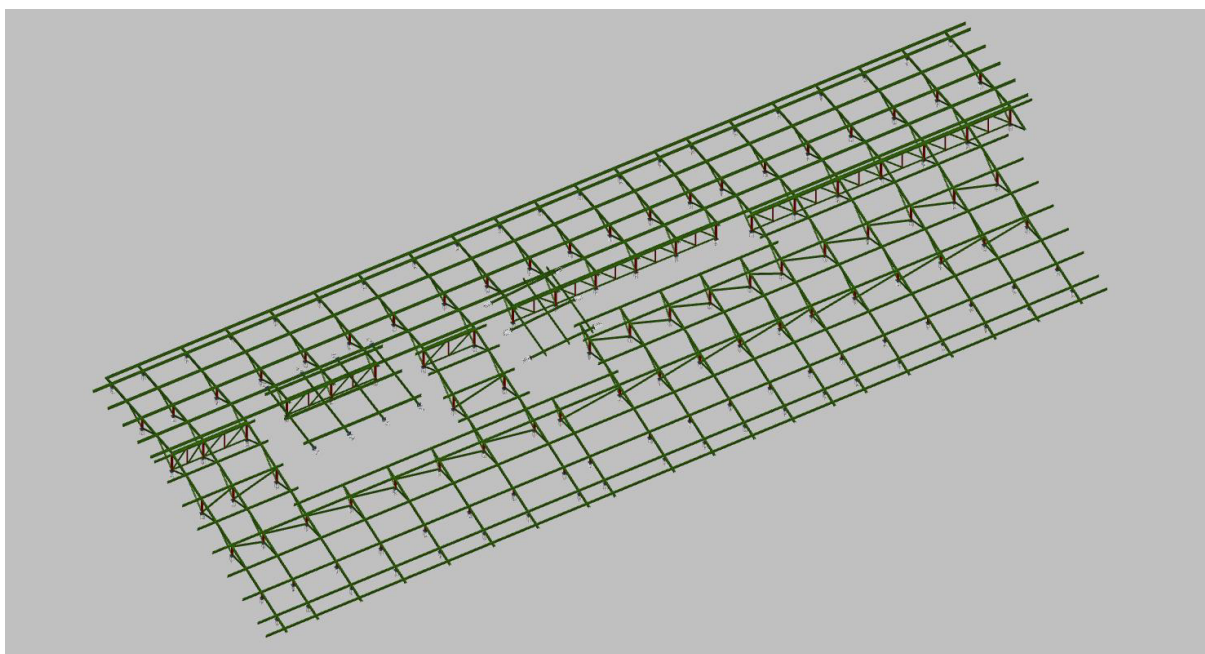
Vista 3D das Coberturas sobre as Lajes da CAPS ADIII
